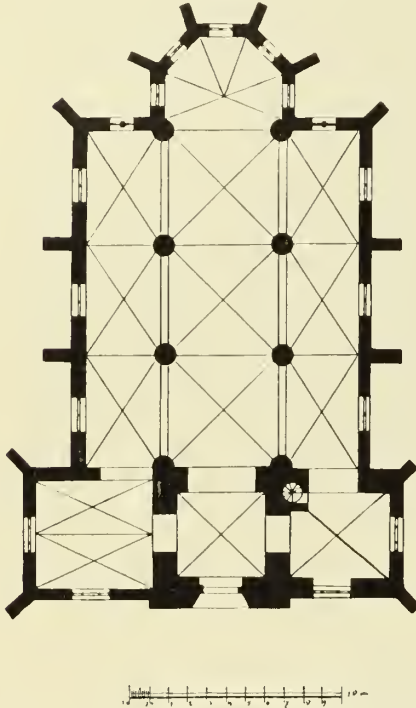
Dinslaken. Grundriss der kathol. Pfarrkirche.
